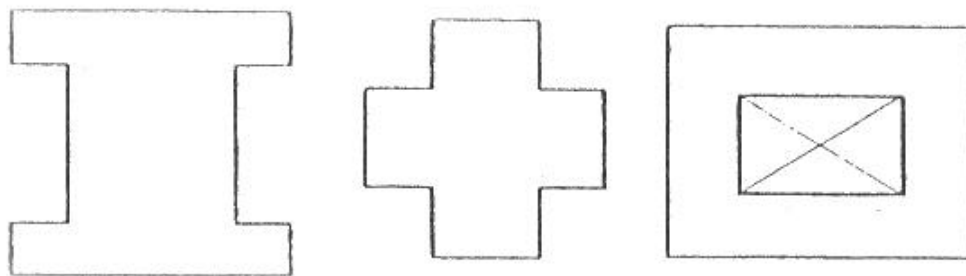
Plantas con esquinas entrantes [Bazán, E., Meli, R. (2002)]
